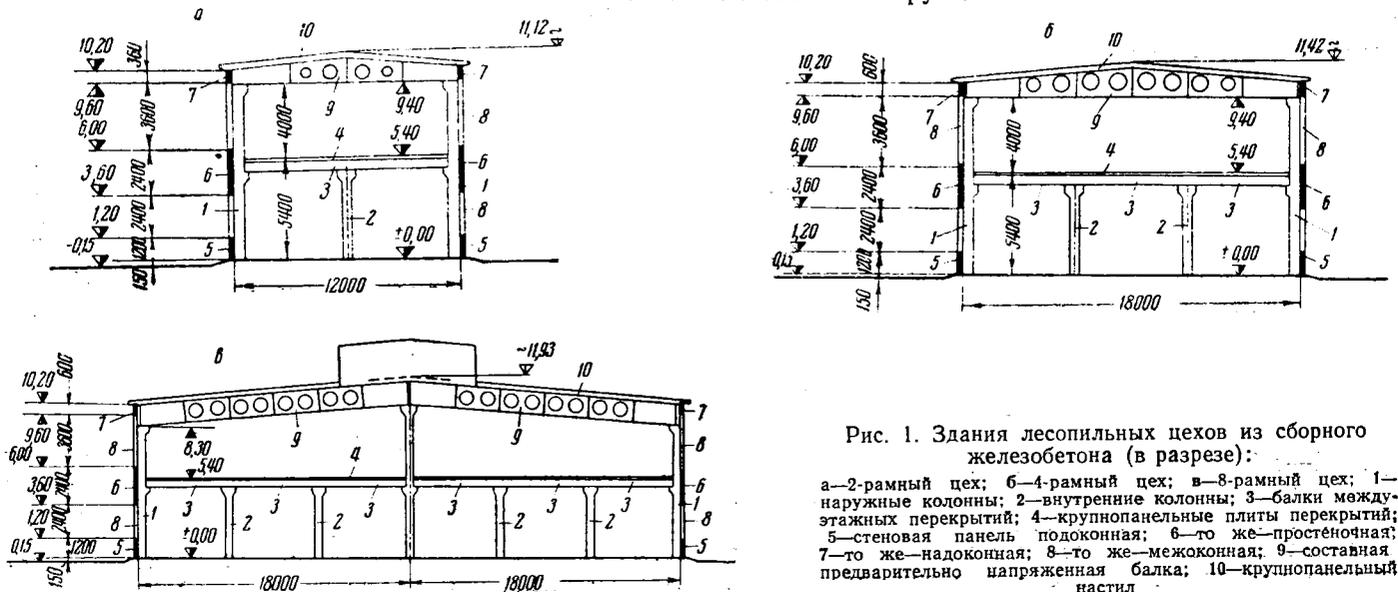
Здания лесопильных цехов из сборного железобетона (в разрезе):
